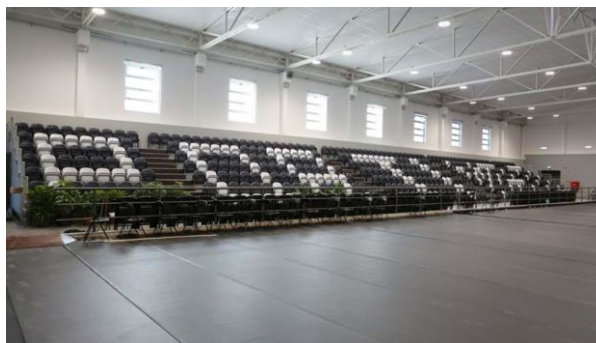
Estrutura cobertura metálica (Record, 10 Dezembro 2019)
